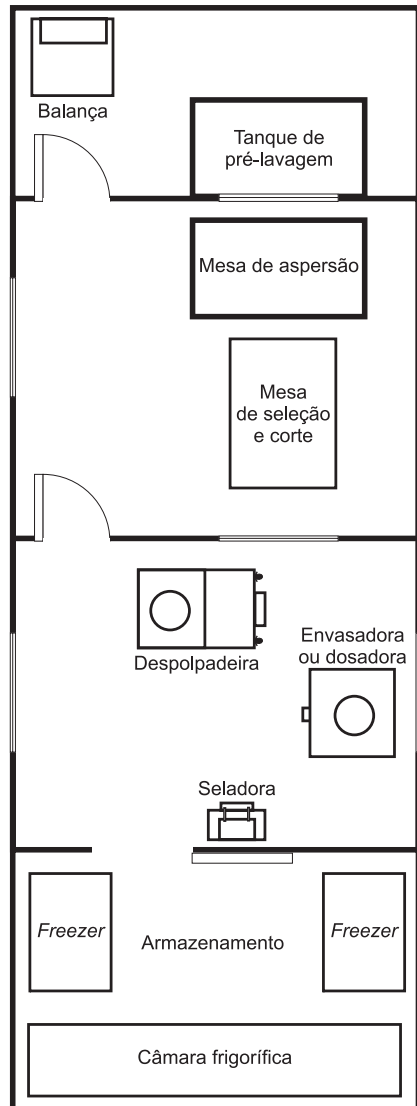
Planta baixa da agroindústria de processamento de polpa de fruta congelada.
